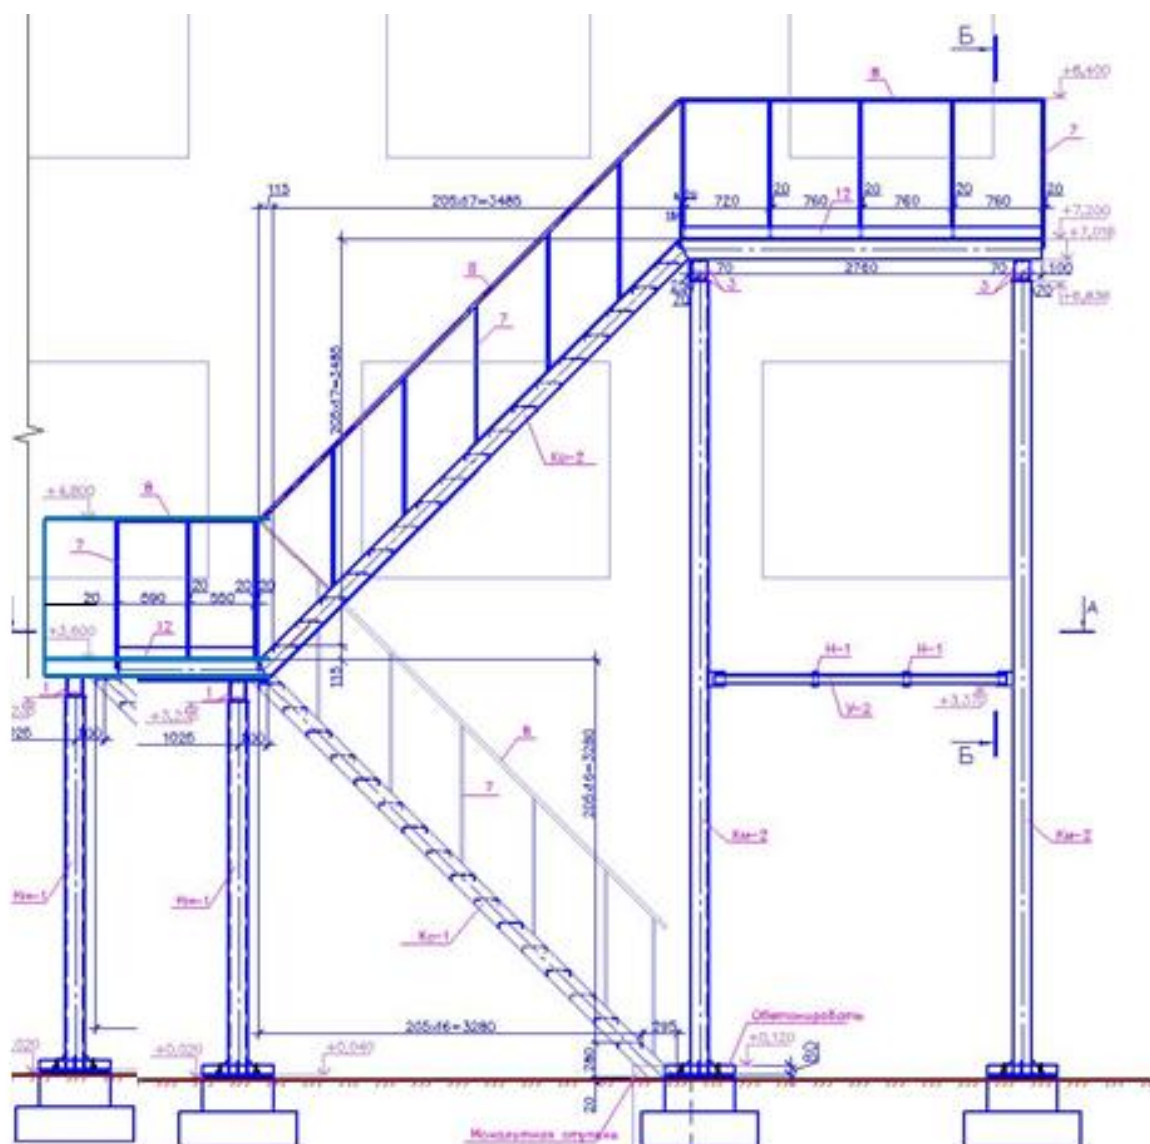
Схема устройства пожарной лестницы для эвакуационного выхода со второго этажа
